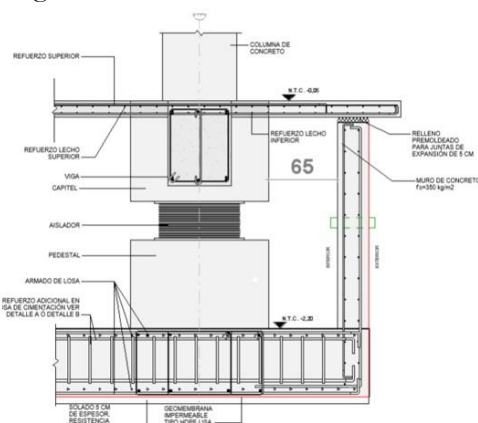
Separación libre para permitir desplazamiento de aisladores.
